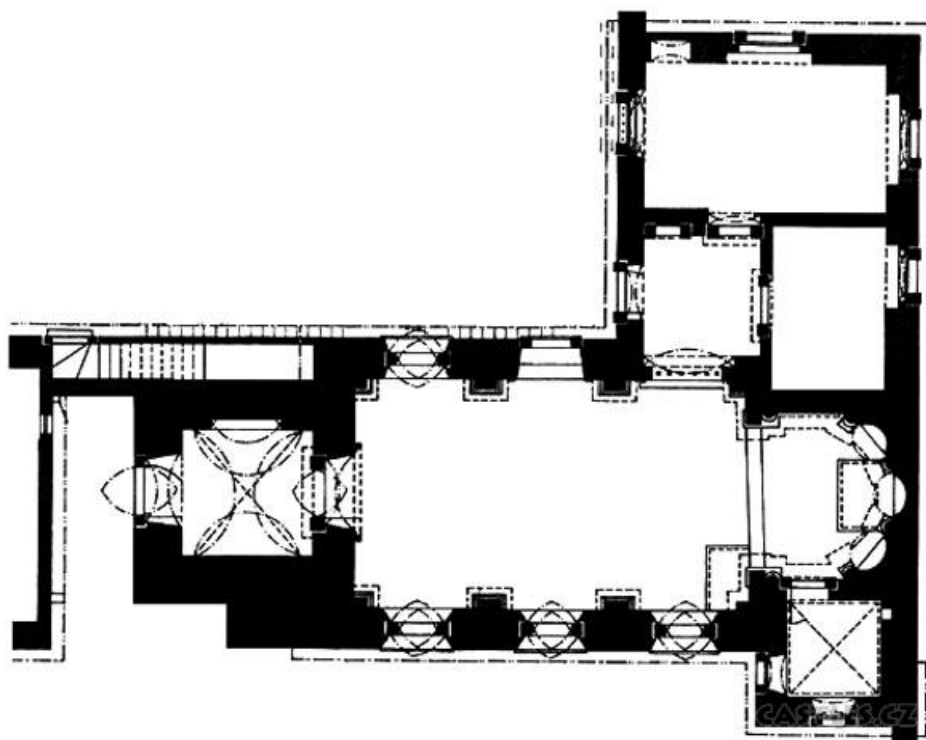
Přízemí „vily“ – půdorys 1:200
